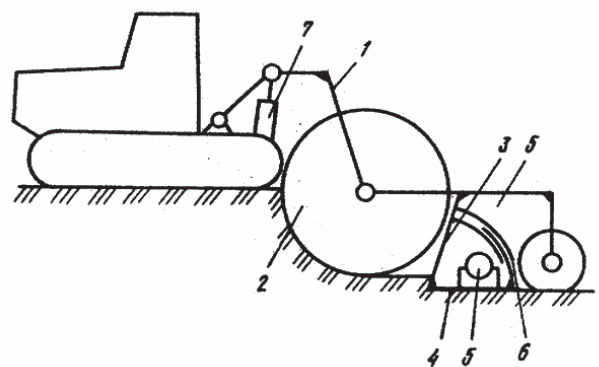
Землеройно-транспортная машина с механизмом направления движения рабочего органа:
